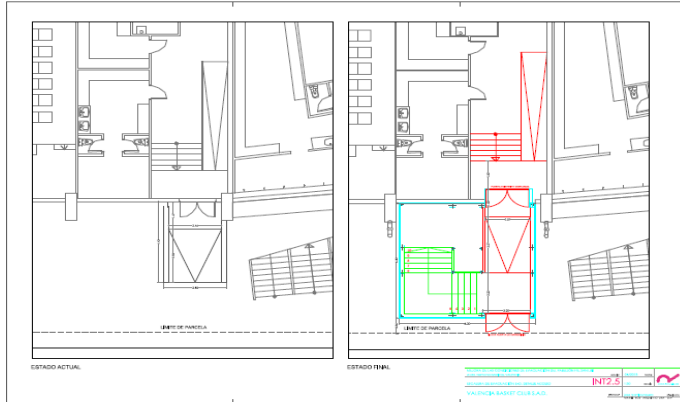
Plano detalle de Acceso a Escalera E-O. Plano 18.
